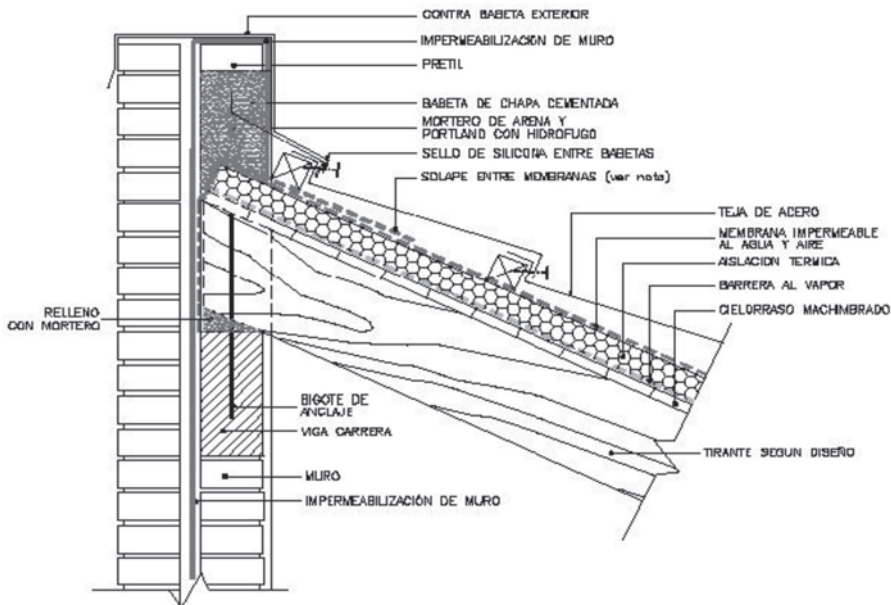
Terminación de pretil con babeta metálica y apoyo de viga en un muro de ladrillo visto
